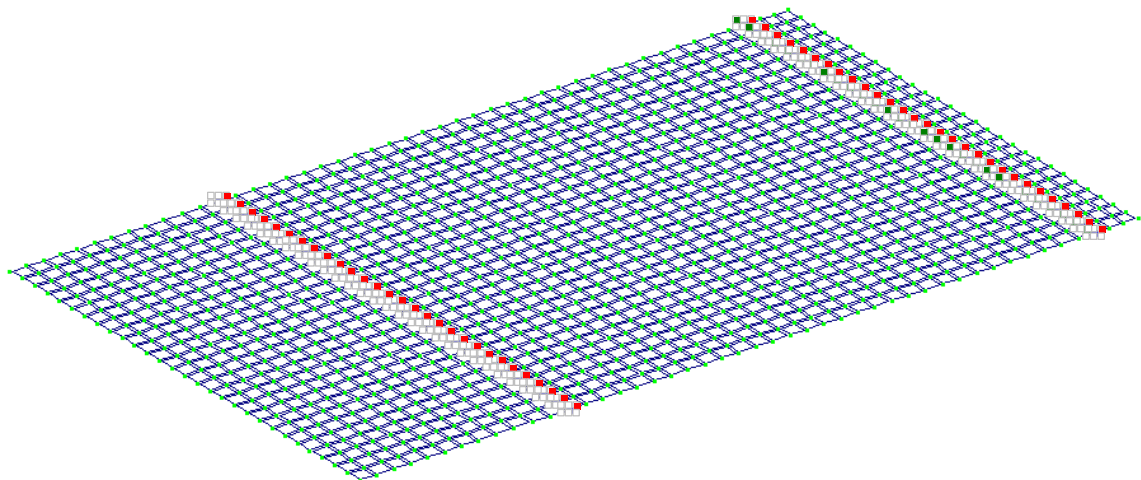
Дискретна модель дорожньої плити із залізобетону
